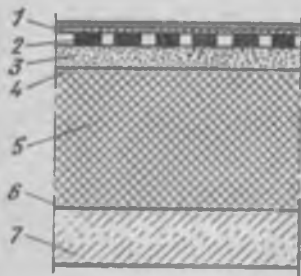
Деталь конструкции пола при наличии тепловой изоляции:
